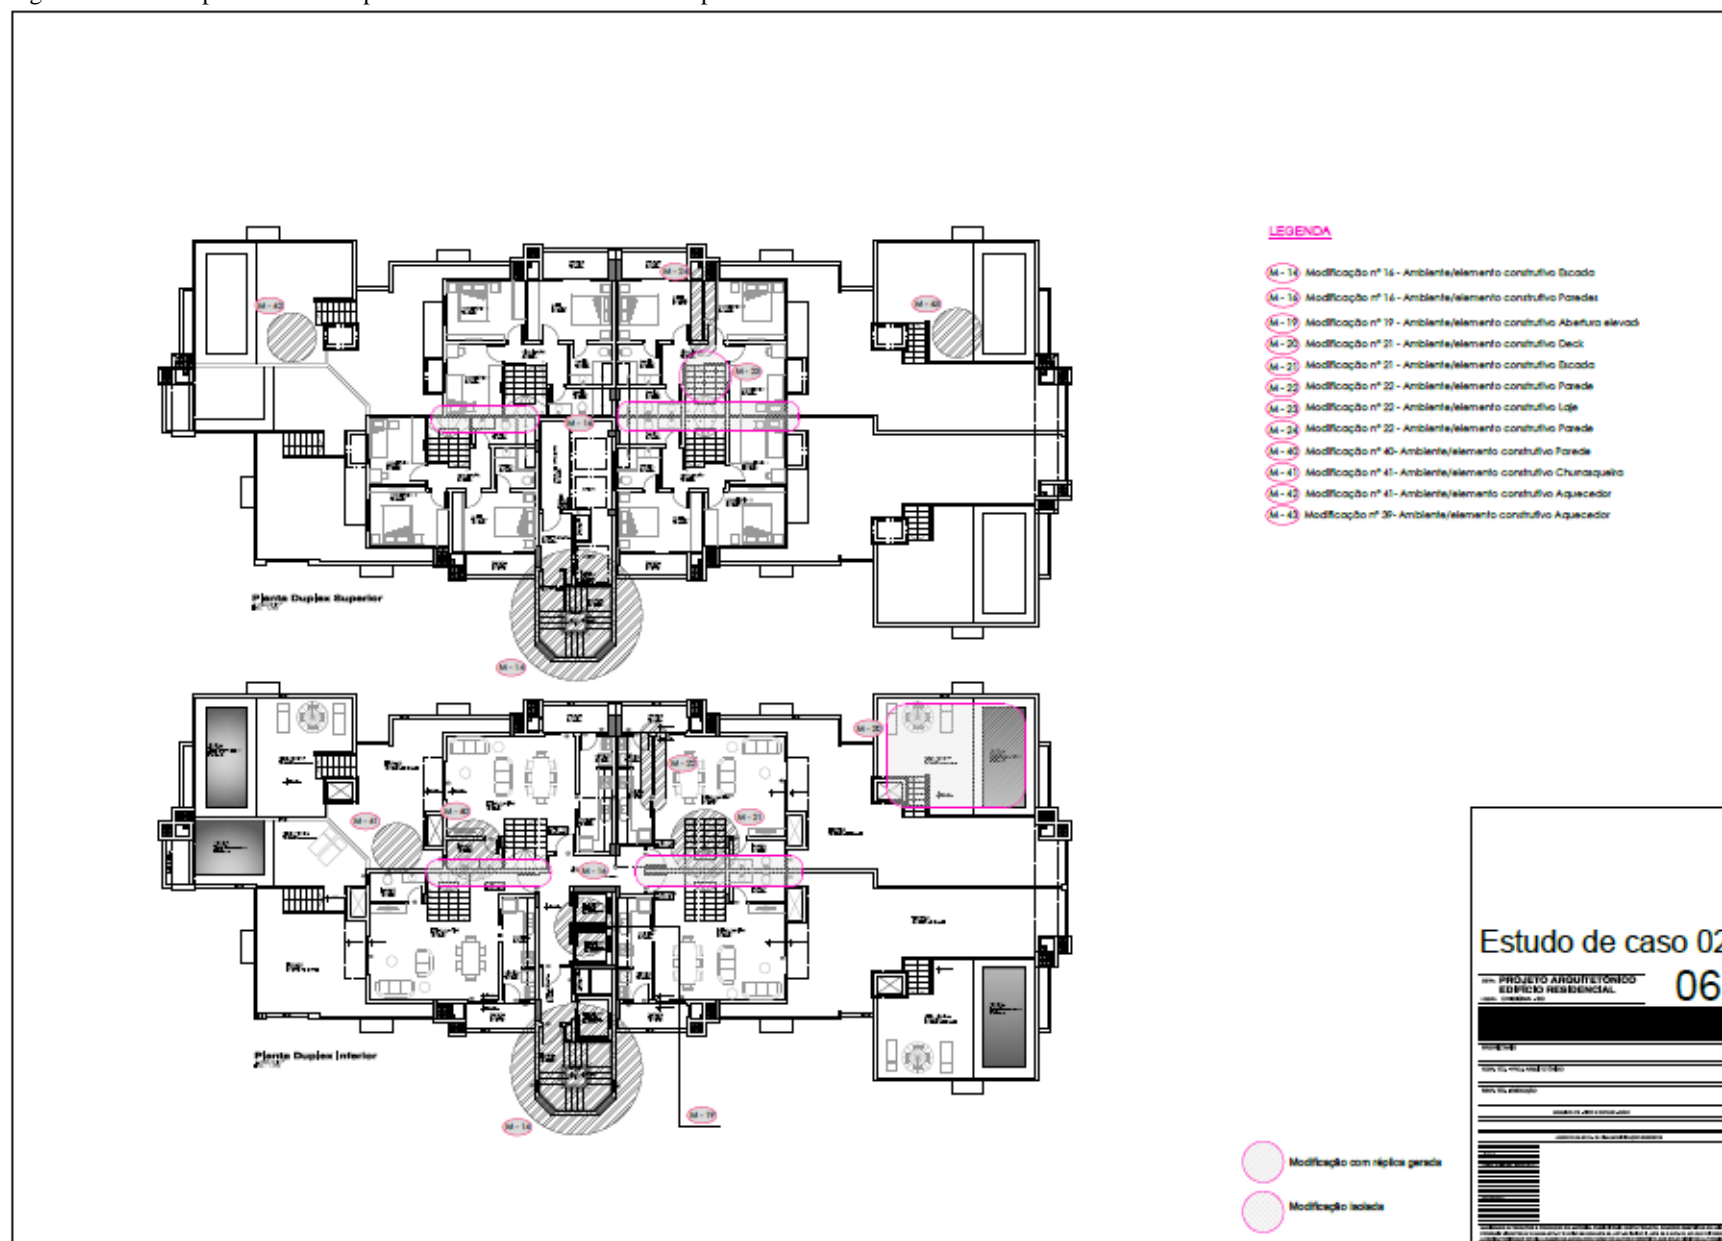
E.C. 02 planta baixa do pavimento cobertura inferior e superior.
